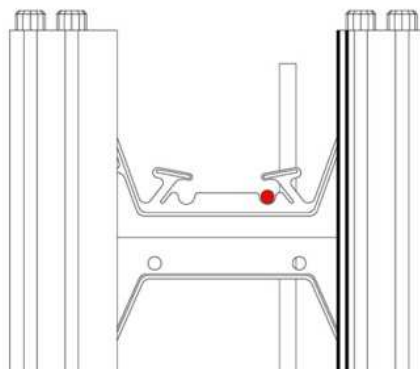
Armadura longitudinal, colocada na ranhura dos espaçadores em aço (ARGISOL, 2010).
